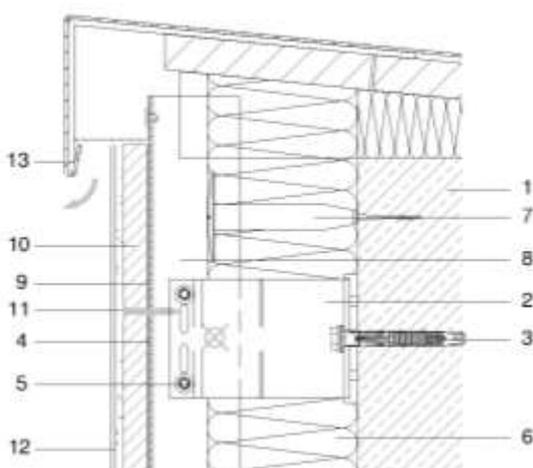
Acabado de la cubierta (fachada ventilada).
